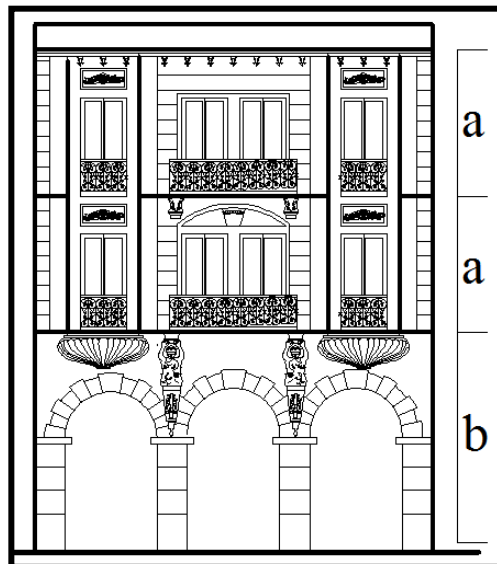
Hauteur de la façade l'immeuble d'habitation N°3
